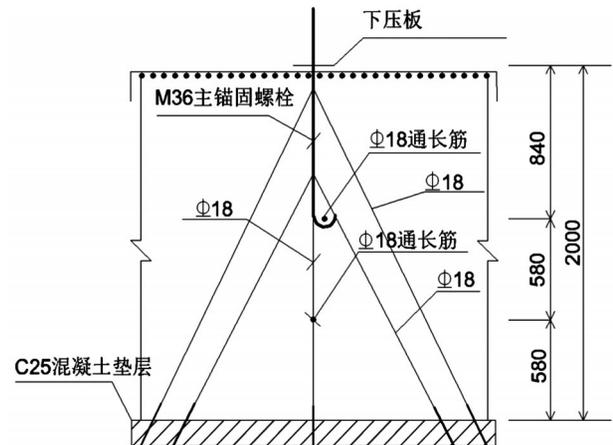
预埋锚固螺栓安装纵剖面示意(单位:mm)
